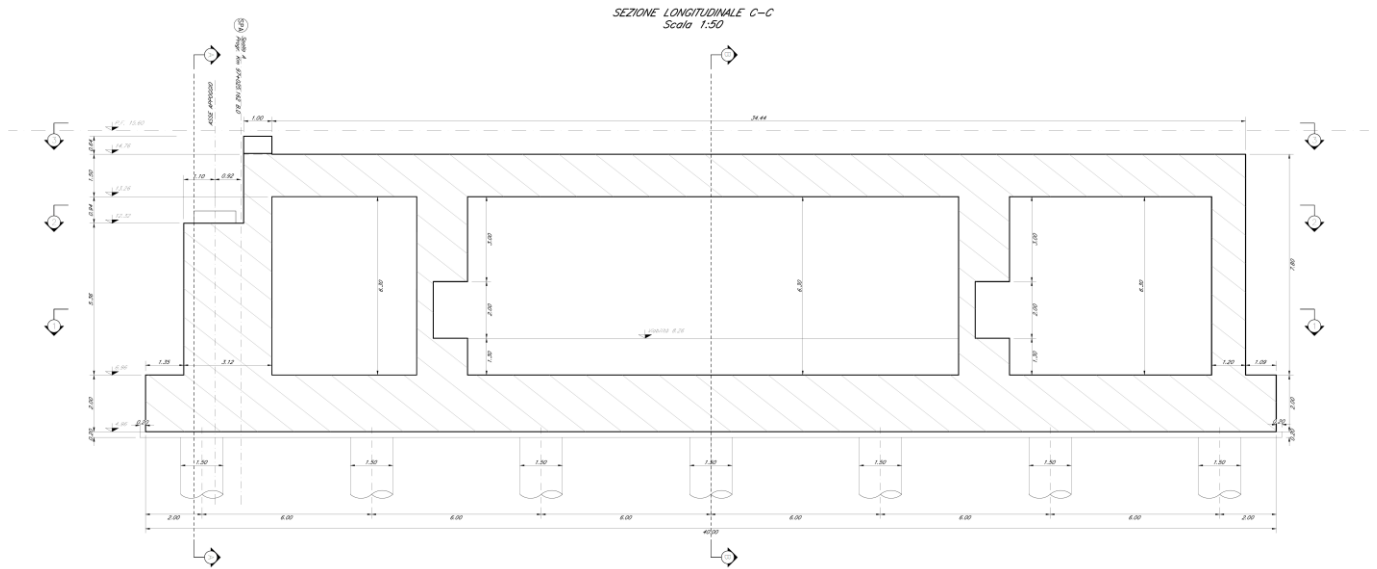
Sezione longitudinale C-C della spalla A (manufatto scatolare) – Lato Genova.
